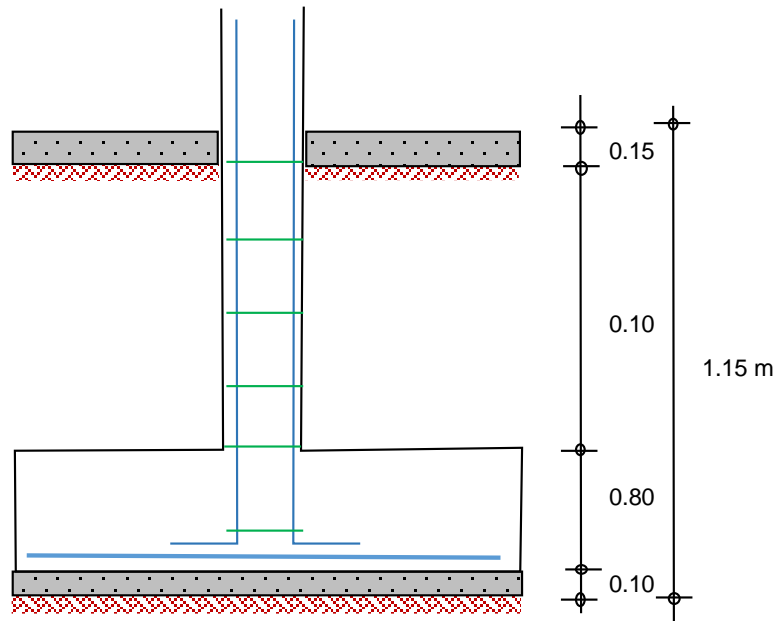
Detalle de sección de la zapatas central (Estructura 1)
